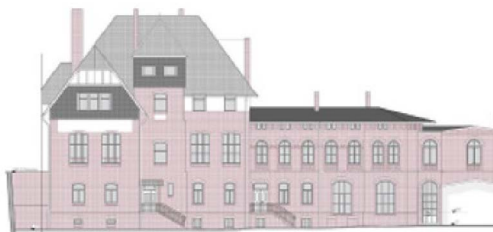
Bahnhofsgebäude (Stadt Doberlug-Kirchhain 2016)
